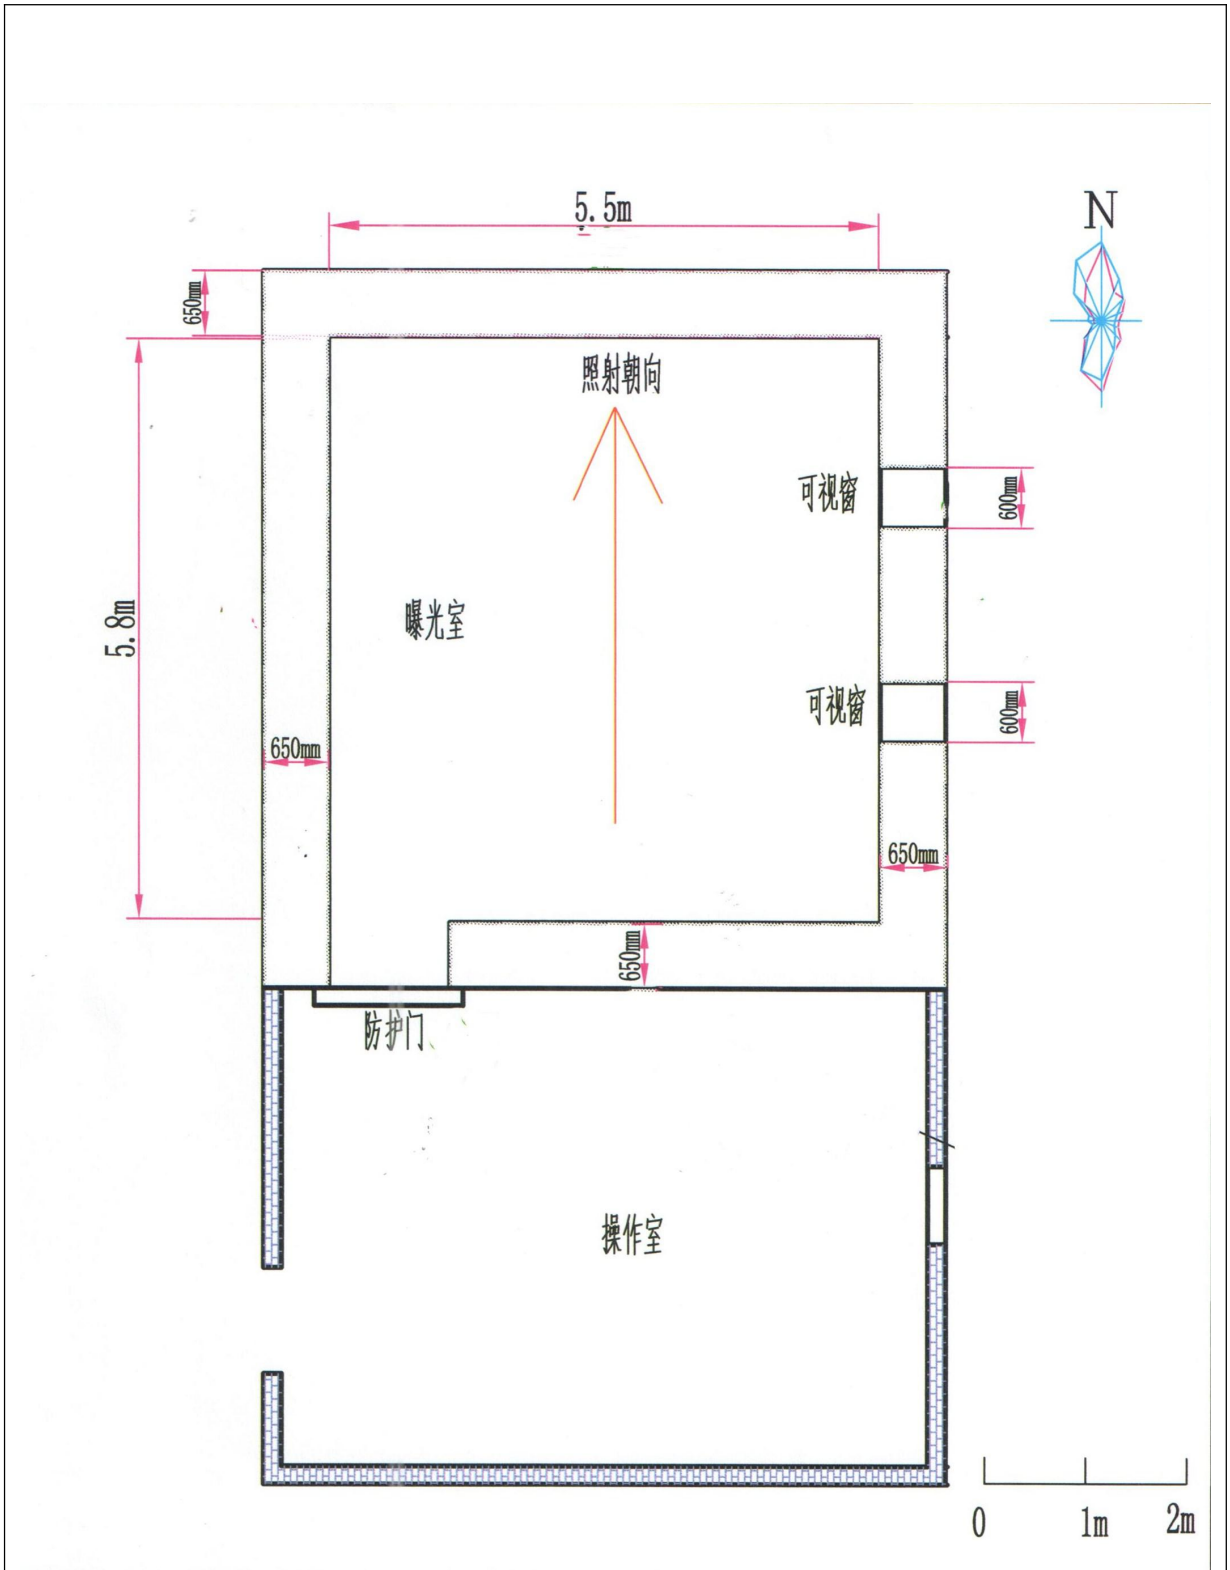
烟台华科检测设备有限公司探伤室平面布置示意图
